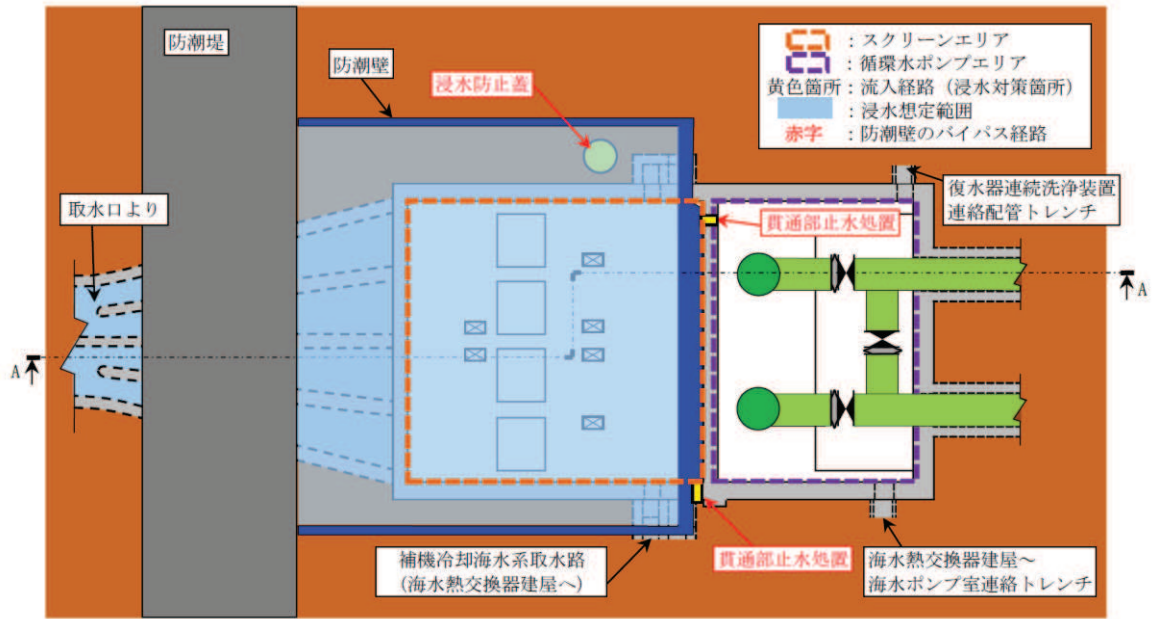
(6) 第 3 号機 海水ポンプ室 流入対策配置図 (平面図)
